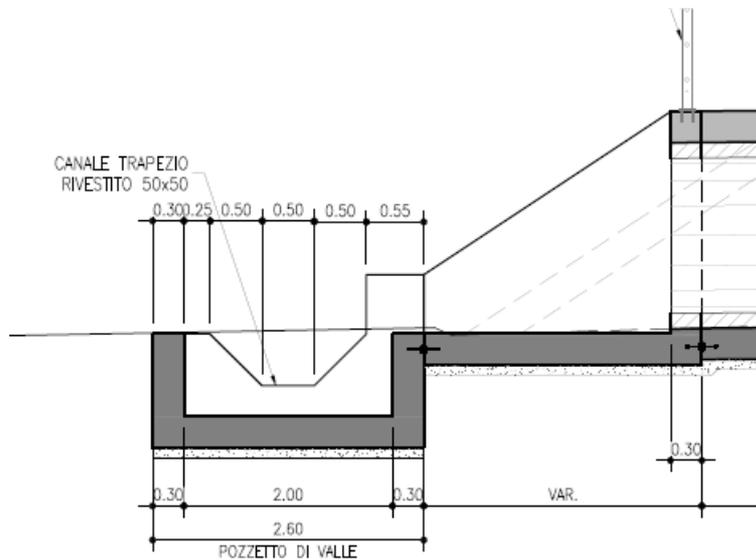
Manufatto di sbocco - Sezione longitudinale
